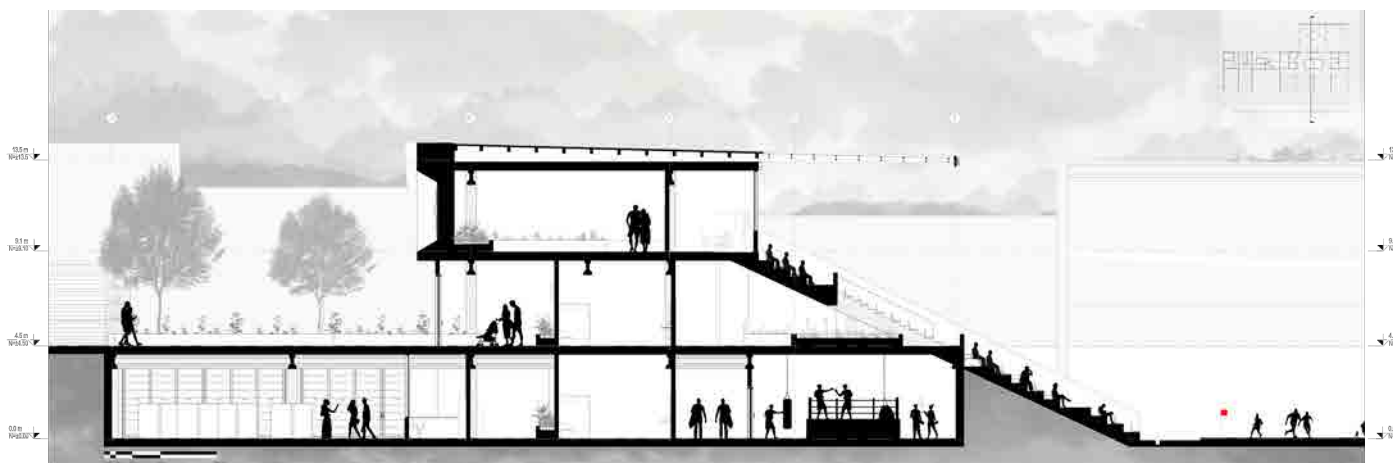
Sección transversal bloque izquierdo. Elaboración: Autores.
